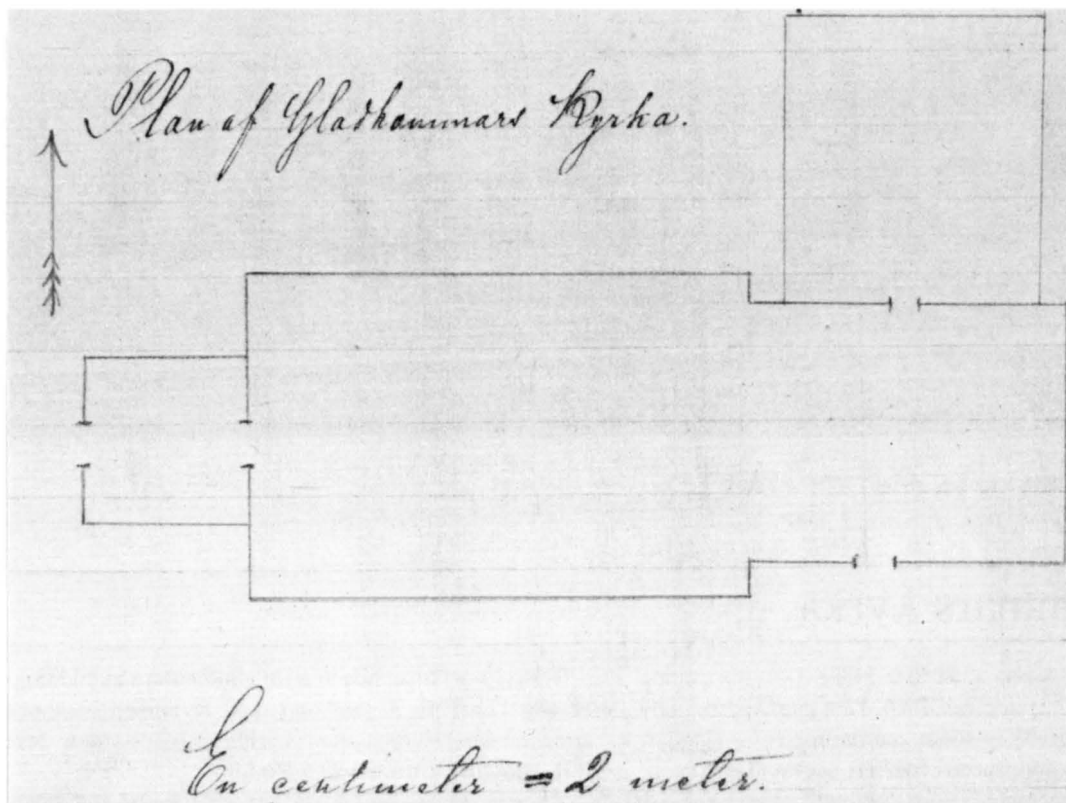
a-b. Sydfasad och plan enligt F J Baehrendtz, 1 : 200, ATA.
